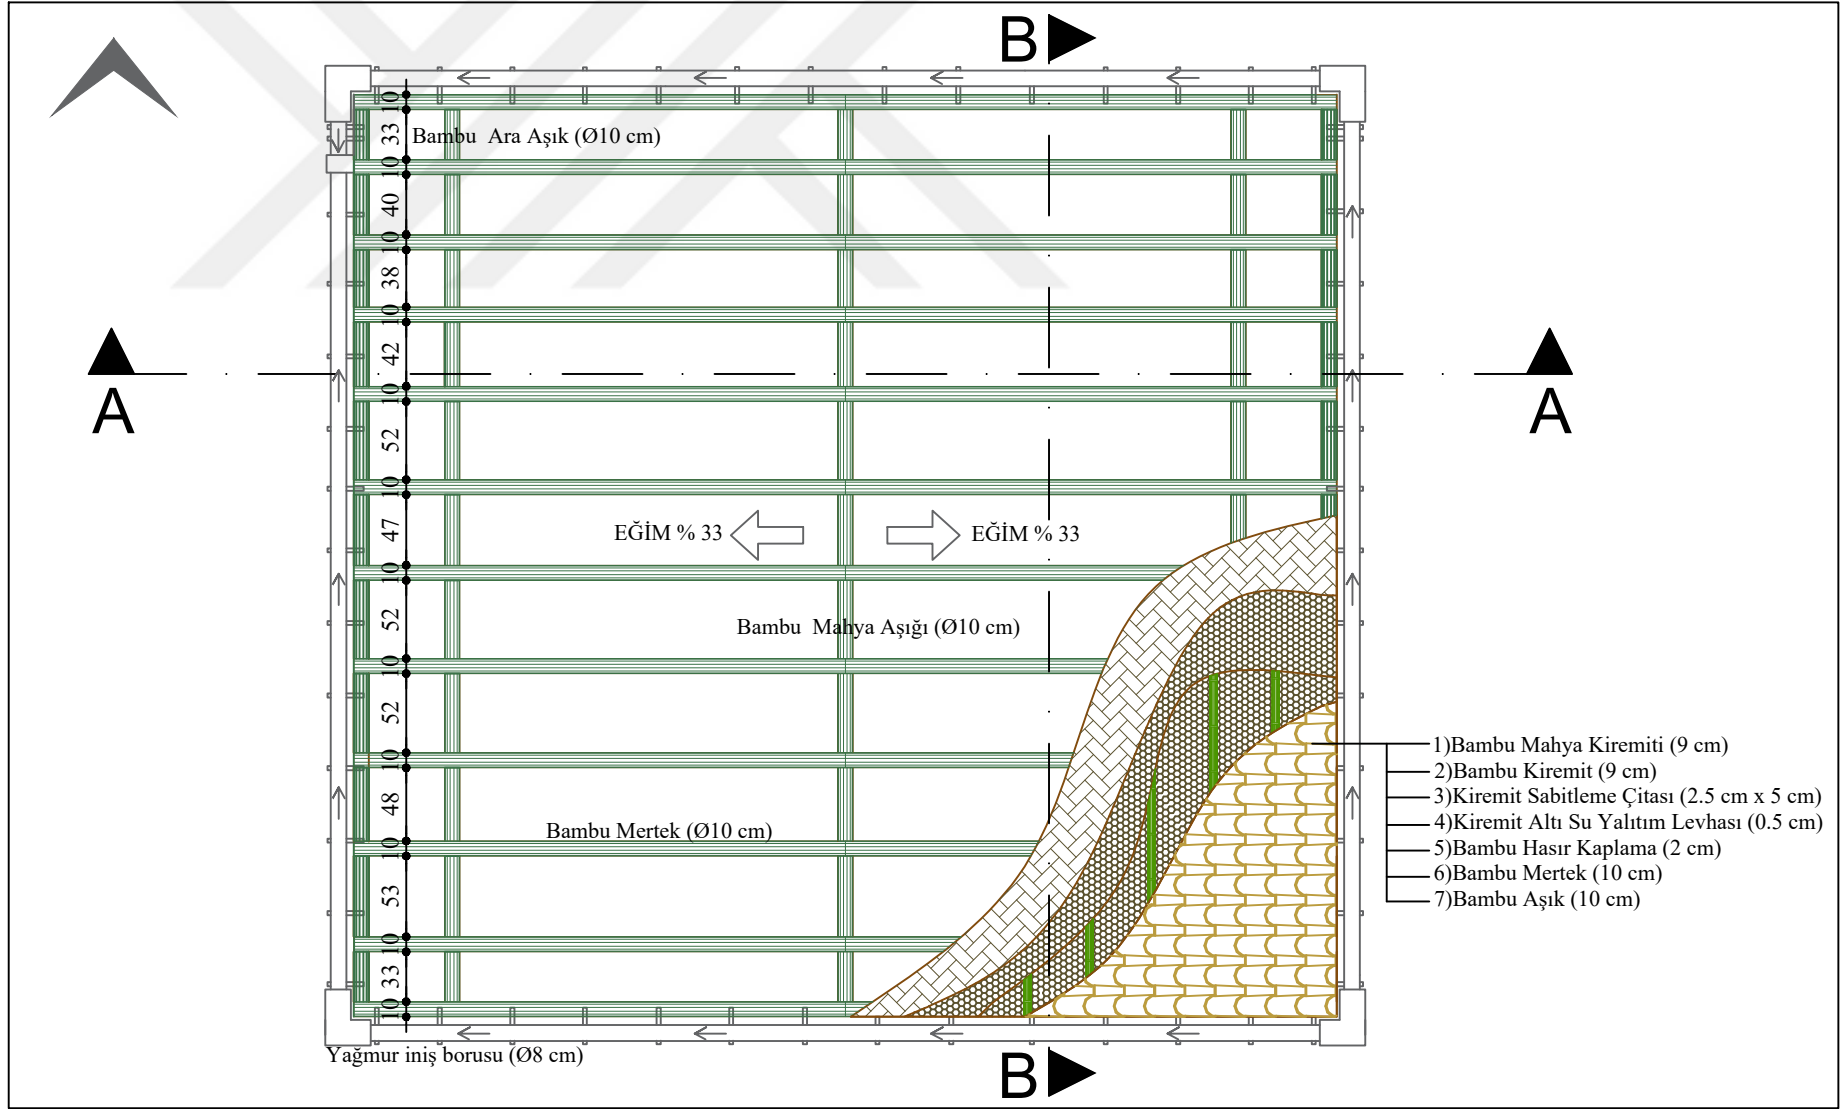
Bambu modelin vaziyet planı ölçek: 1/60
